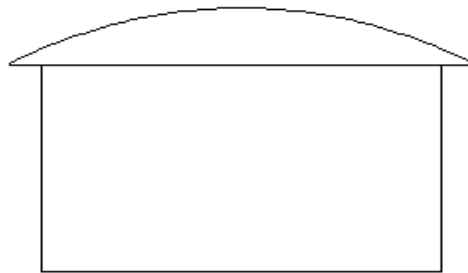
Surfaces des ouvertures sur la façade latérale gauche
